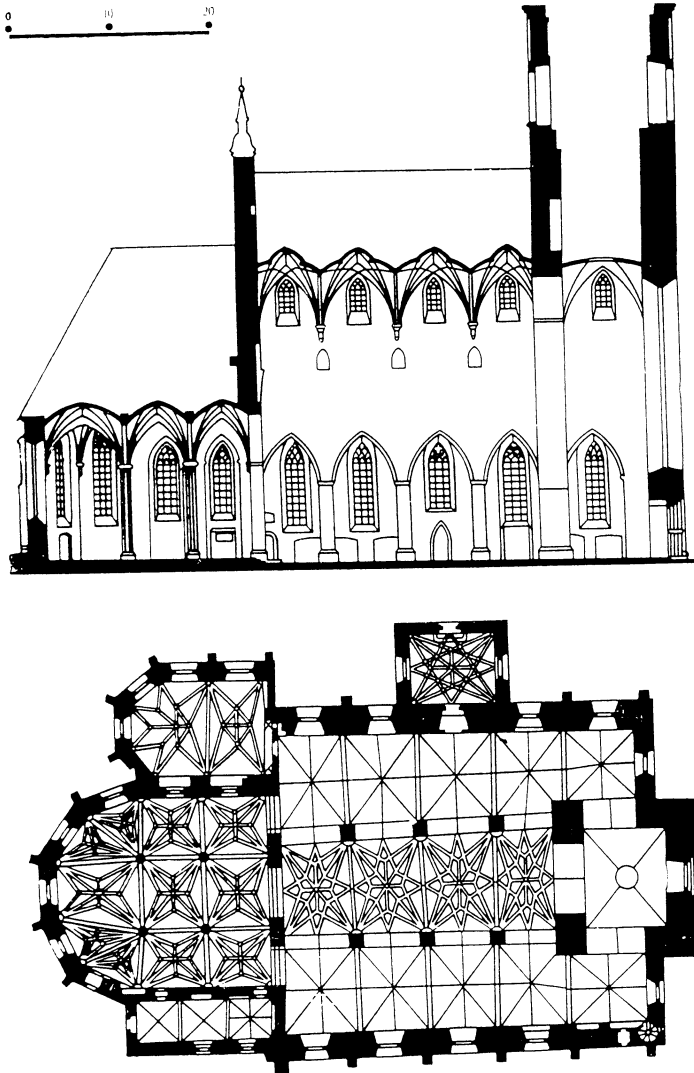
Reval (estn. Tallinn): Grundriss und Längsschnitt der Olai kirche
